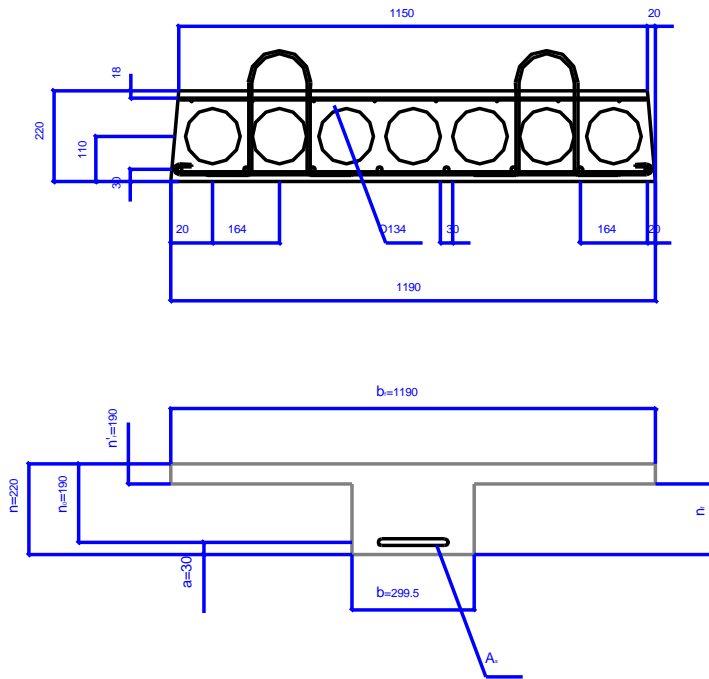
Поперечний перетин плити перекриття ПК 66-12-8, та приведений поперечний перетин.
